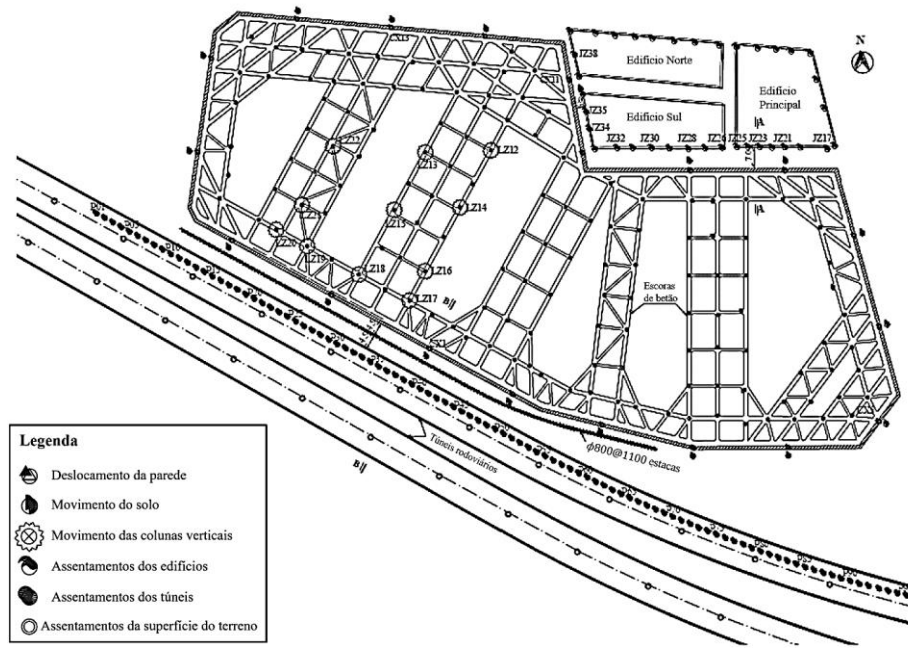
Planta da escavação do edifício DingDing Bund
